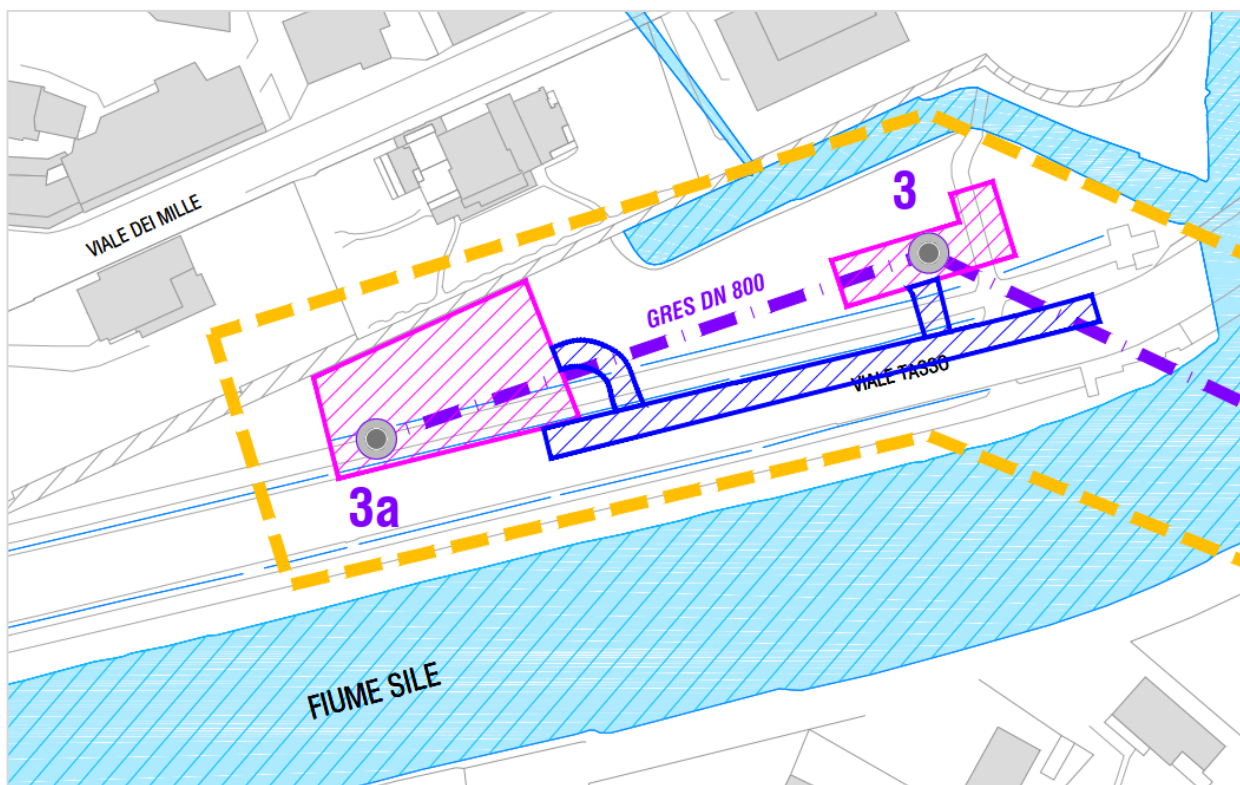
D : Inquadramento planimetrico area cantiere pozzo S3
